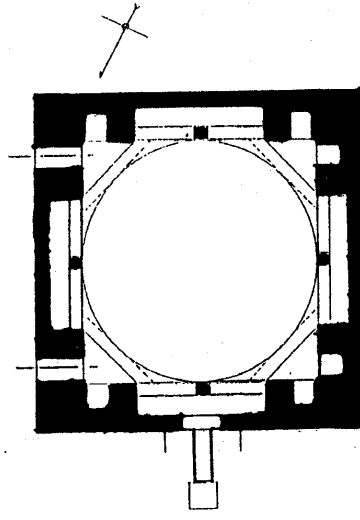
مسقط أفقي لمدفن سليمان أغا الحنفي بالأباجية
